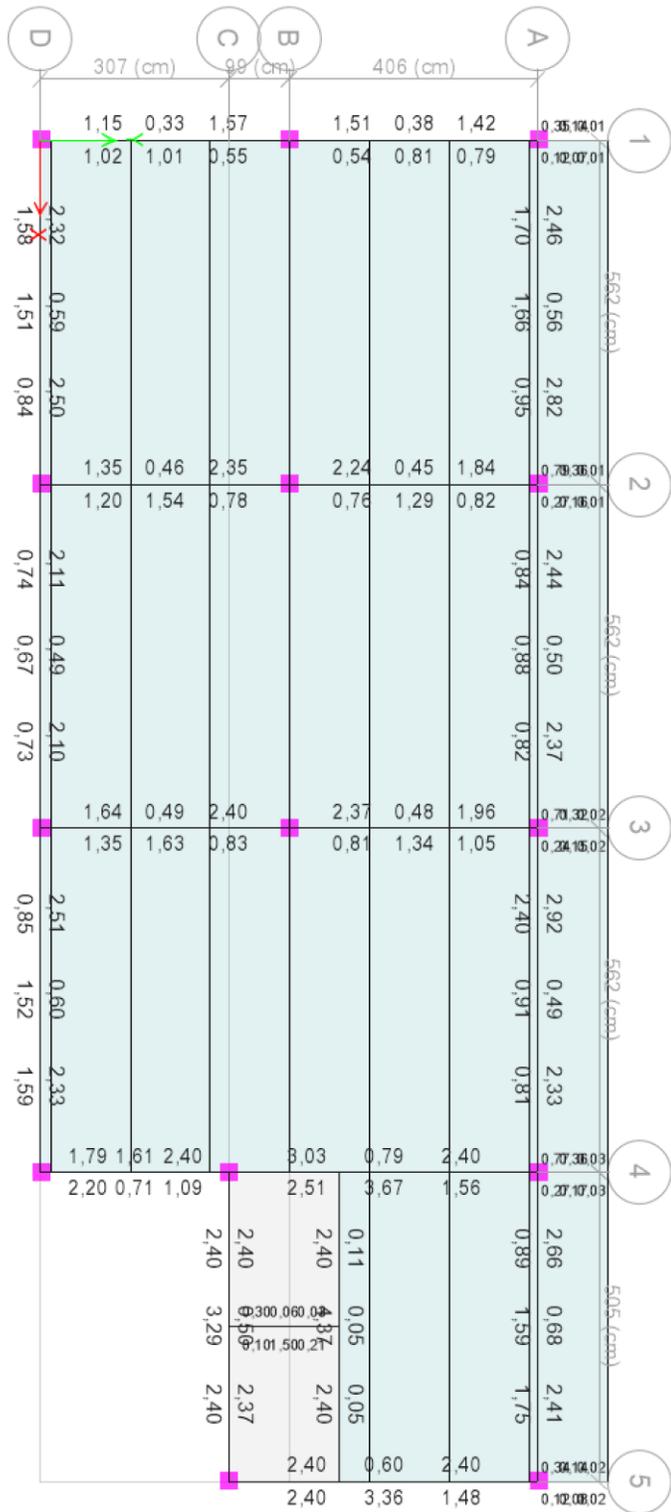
Acero requerido por vigas en cubiertas (en cm<sup>2</sup>)
